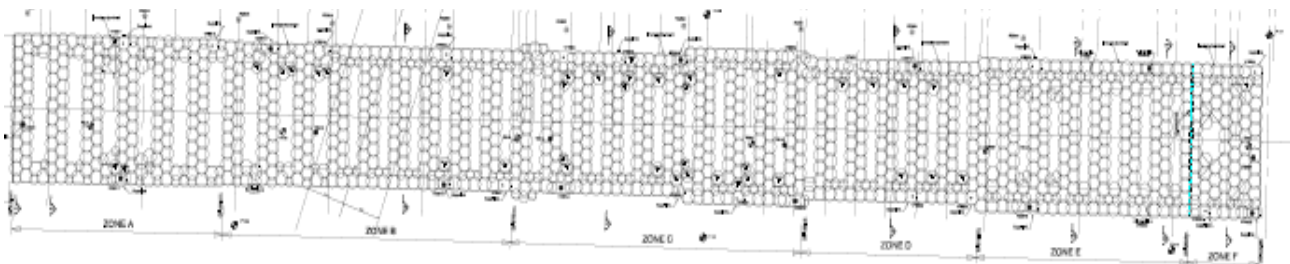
Grundrissplan der Jettingsohle
